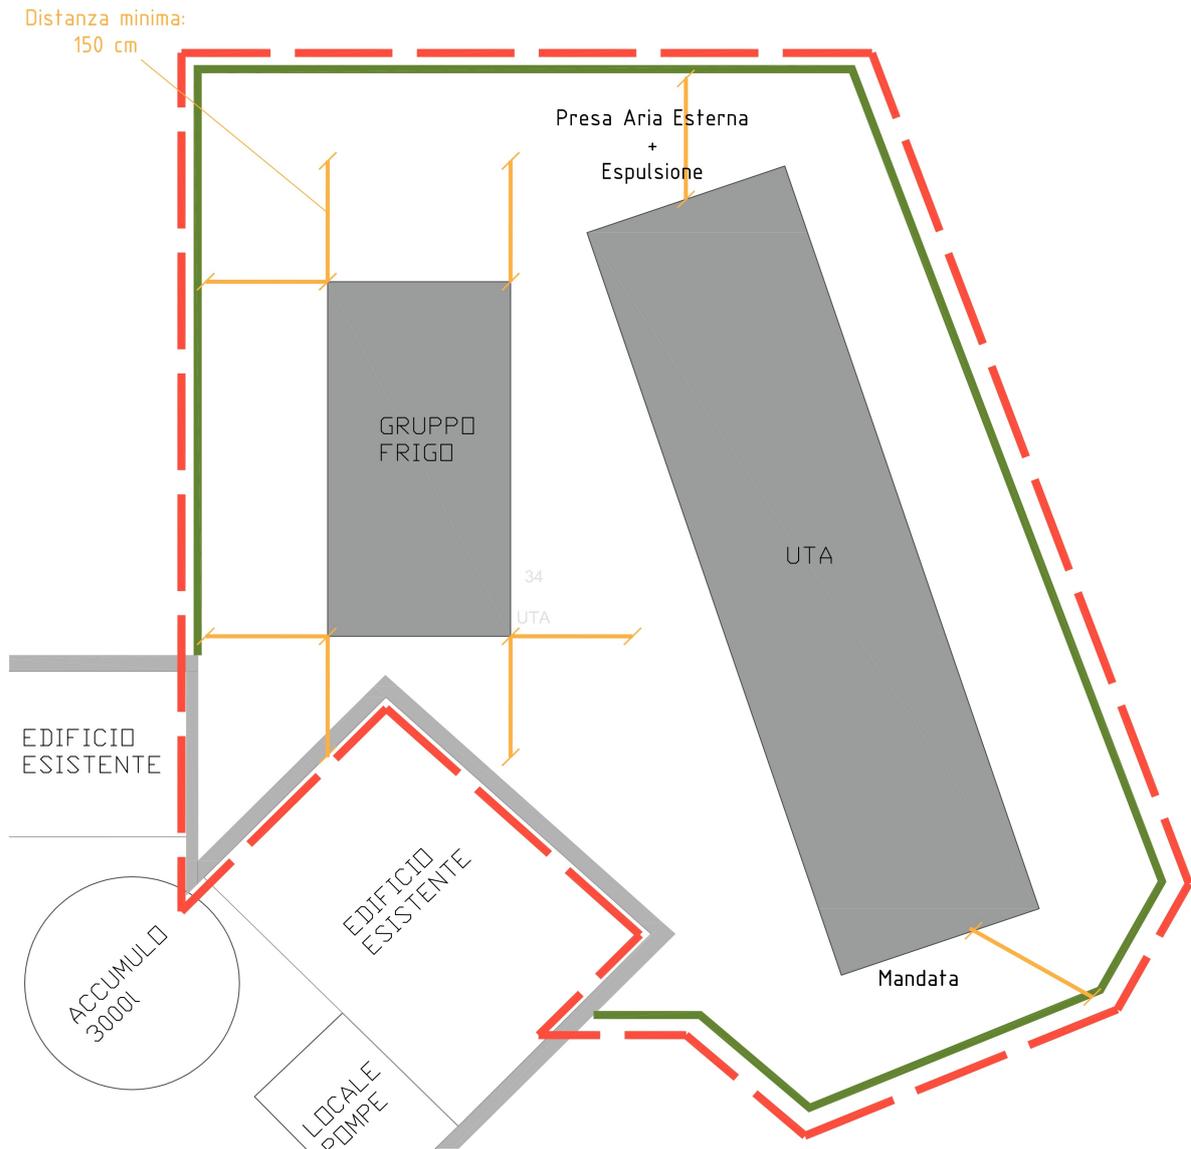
Planimetria dell'area di dettaglio con indicata la posizione degli impianti tecnologici
